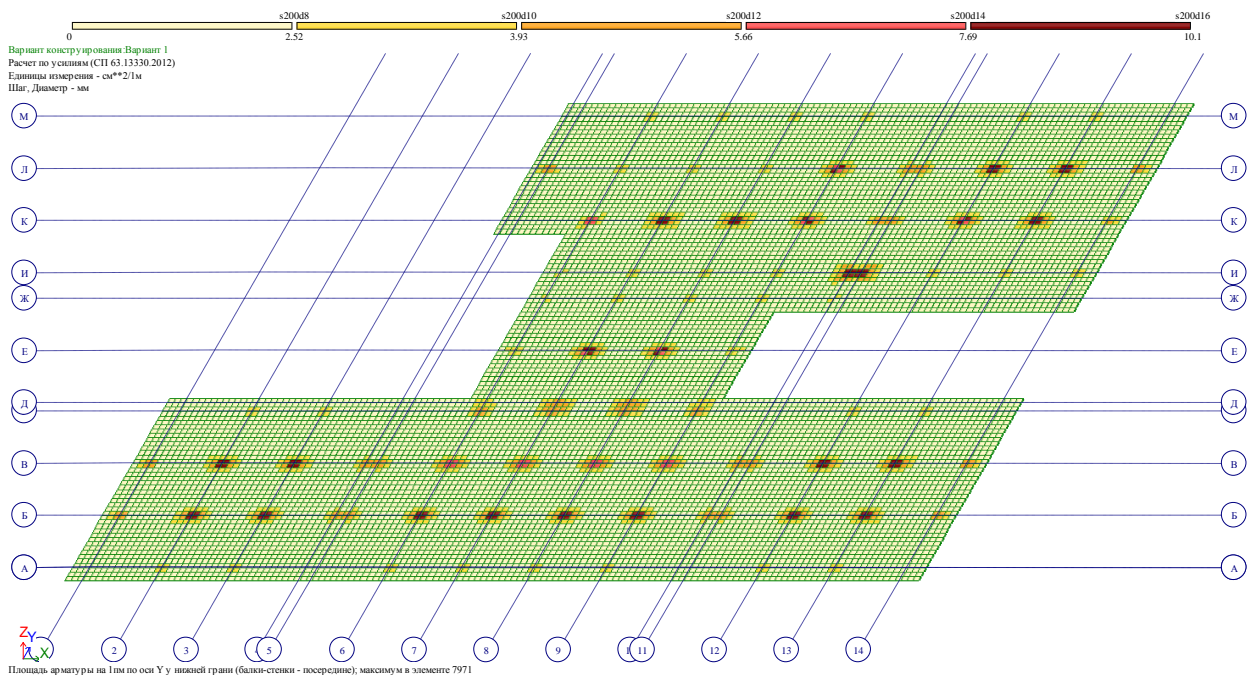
Площадь арматуры по оси Y у нижней грани
